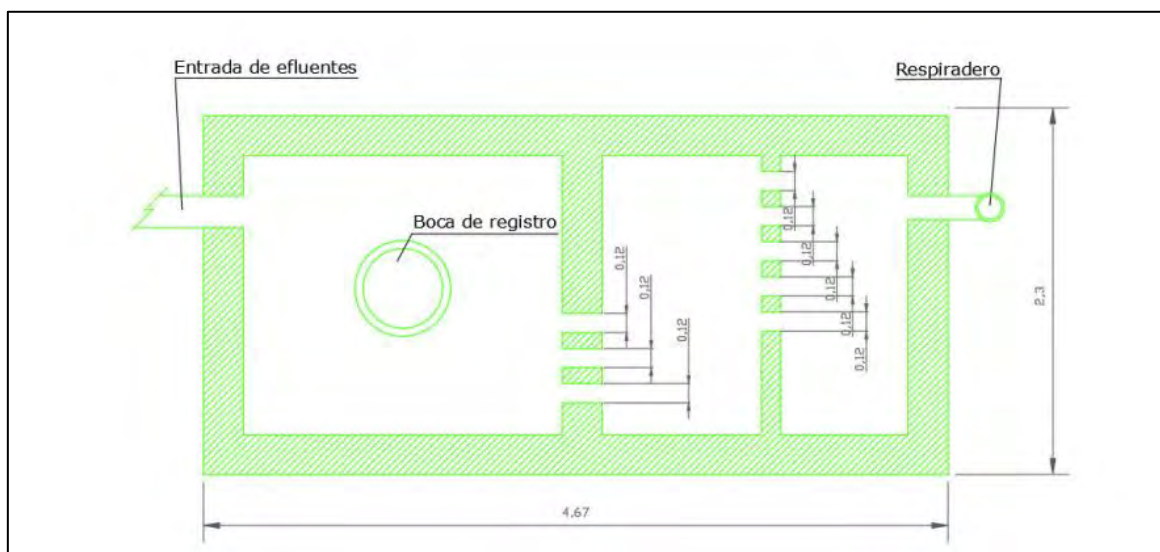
Esquema de Esquema de la fosa séptica existente. Planta
